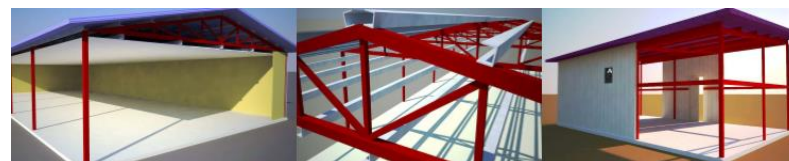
Sistema constructivo de montaje de Paneles Sándwich. Fotos extraídas de: KOSF
